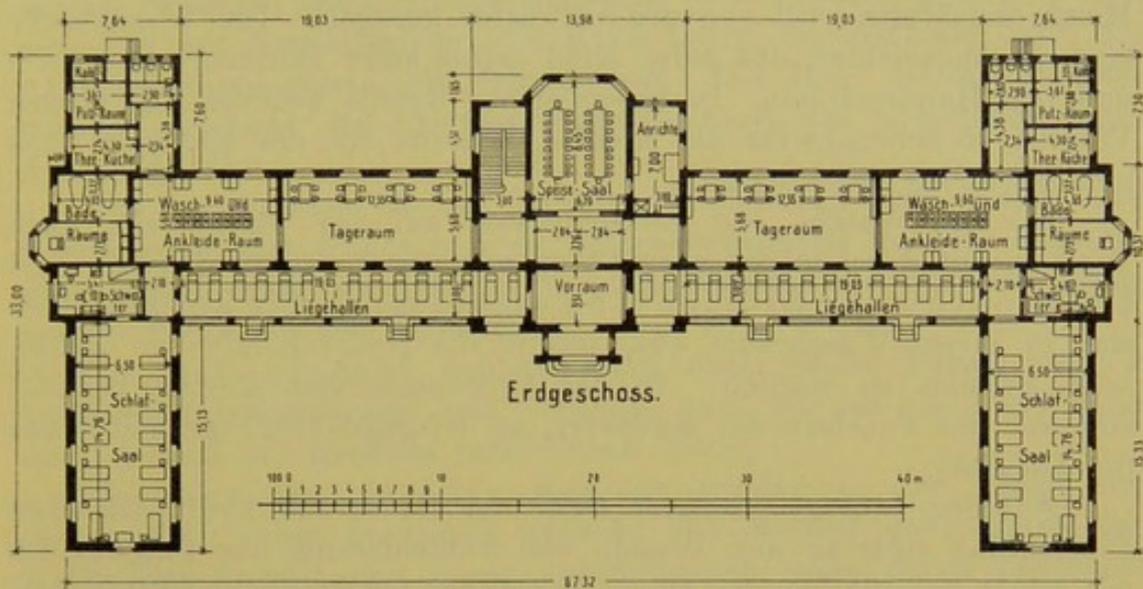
Grundriß der Kinderheilstätte Belzig.
